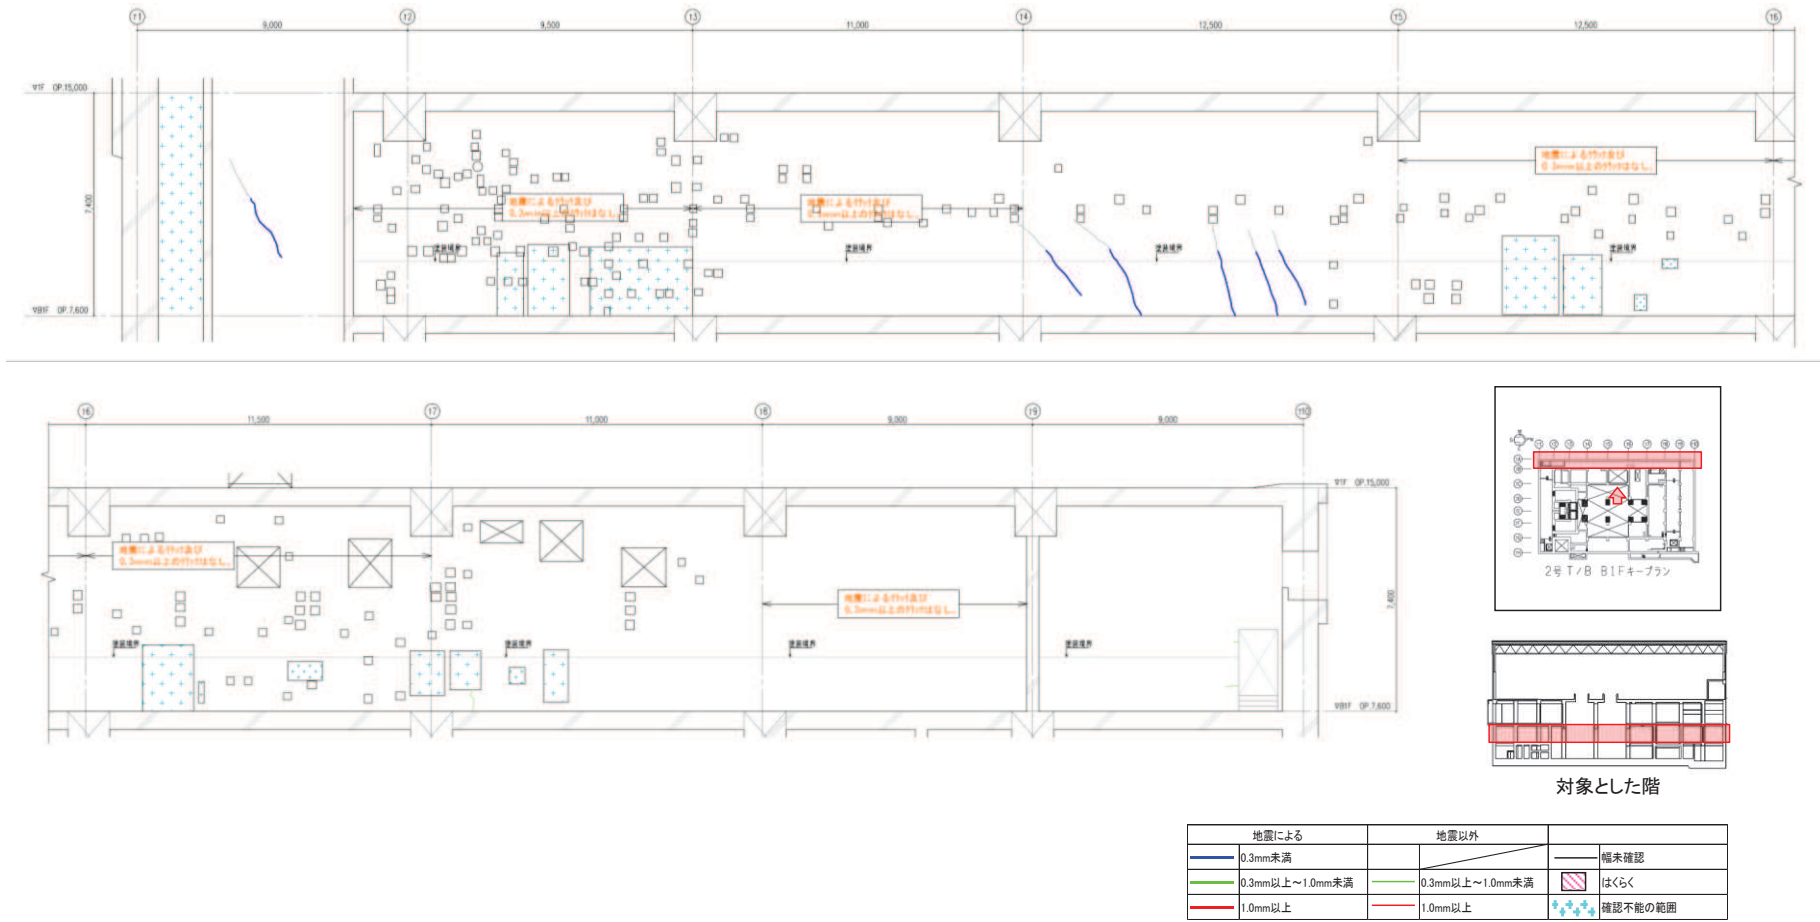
タービン建屋のひび割れ分布 耐震壁 (26) 地下 1 階 TA 通り
